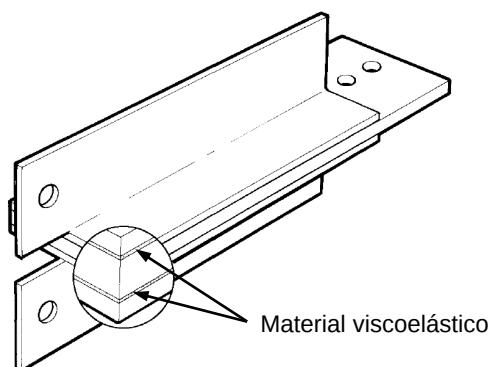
Exemplo da aplicação de materiais viscoelásticos em estruturas metálicas (adaptado de CALDWELL, 1986).
